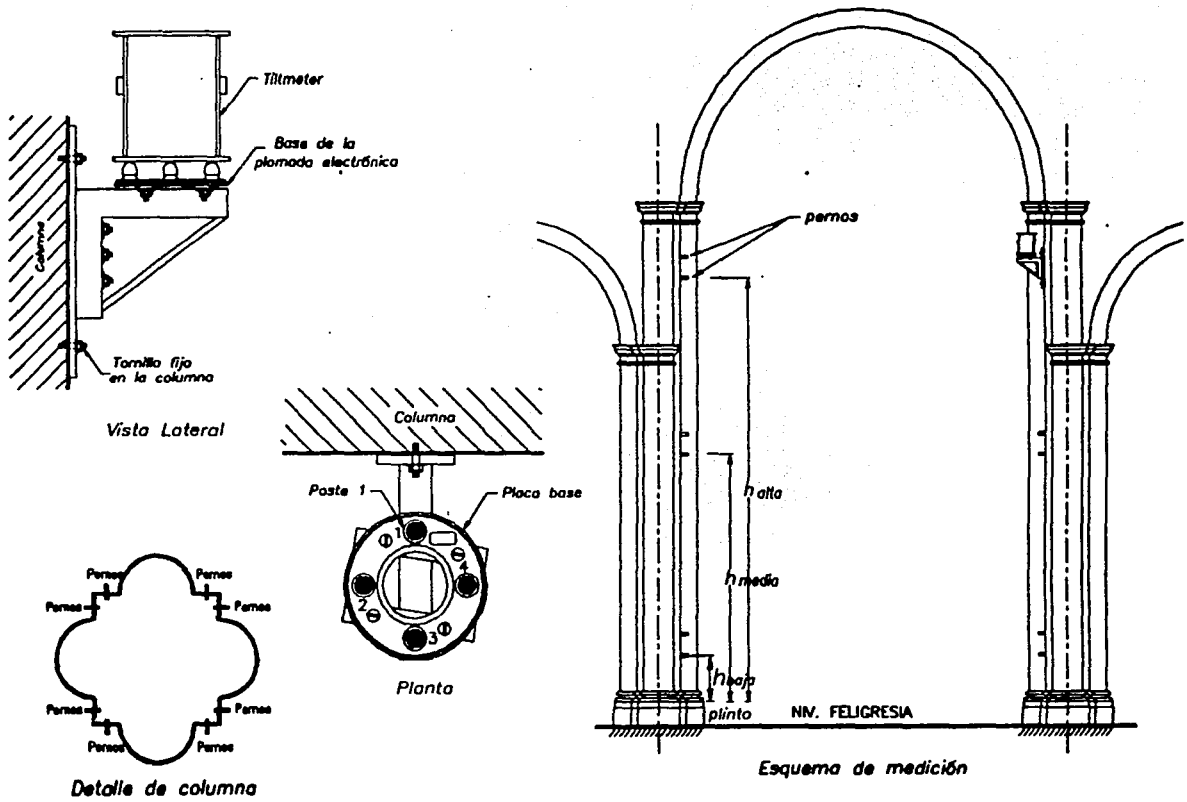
Equipo utilizado para medir el giro de las columnas con tiltmeter.
